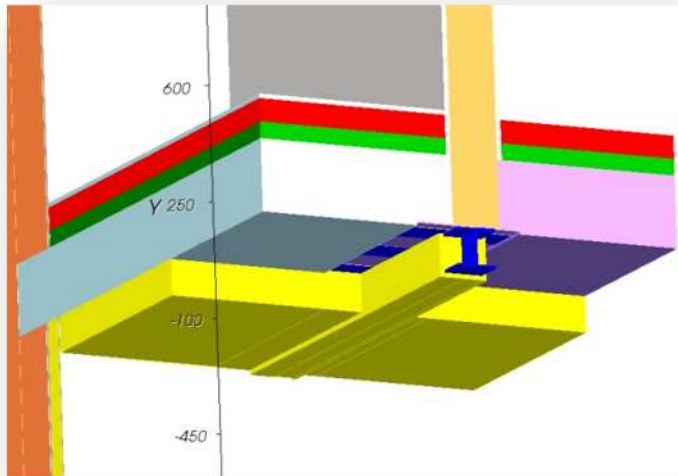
Detail - Auflagerbereich Stahlträger zur Unterfangung einer Trennwand, links Anschluss Doppelbaumdecke, rechts Anschluss Stahlbetondecke, abgehängte Decke nicht dargestellt (o.M.)
